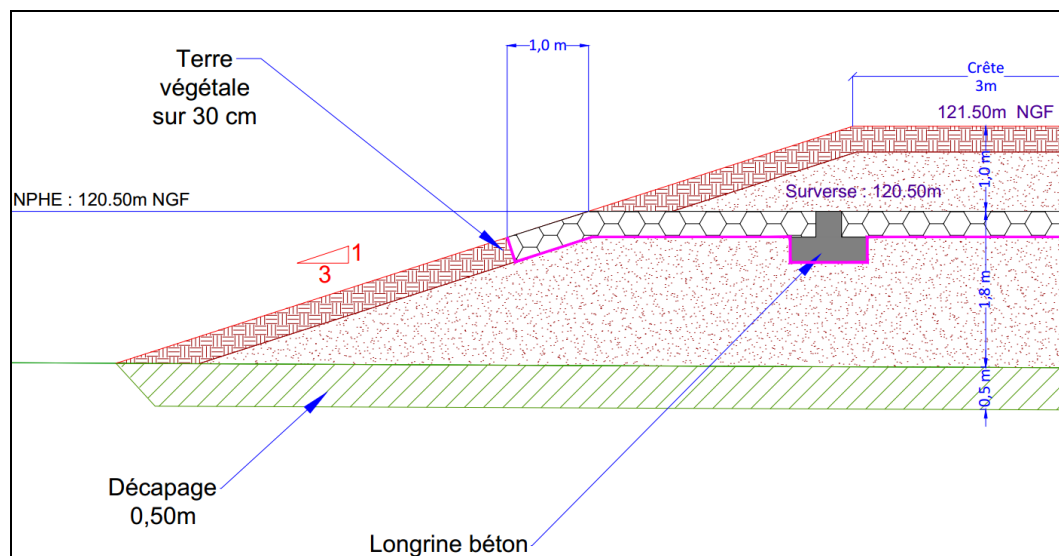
Ouvrage D19-8 - Coupe en travers du corps de l'ouvrage (parement amont)
